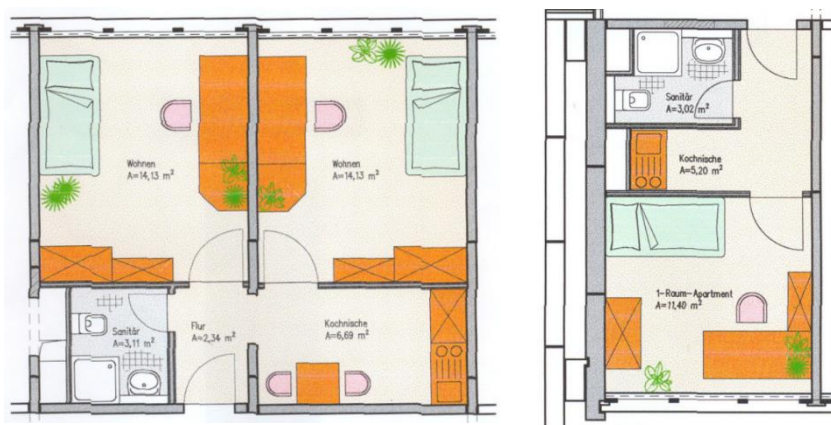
links: Grundriss 2er-WG, rechts: Grundriss Appartement [18]
